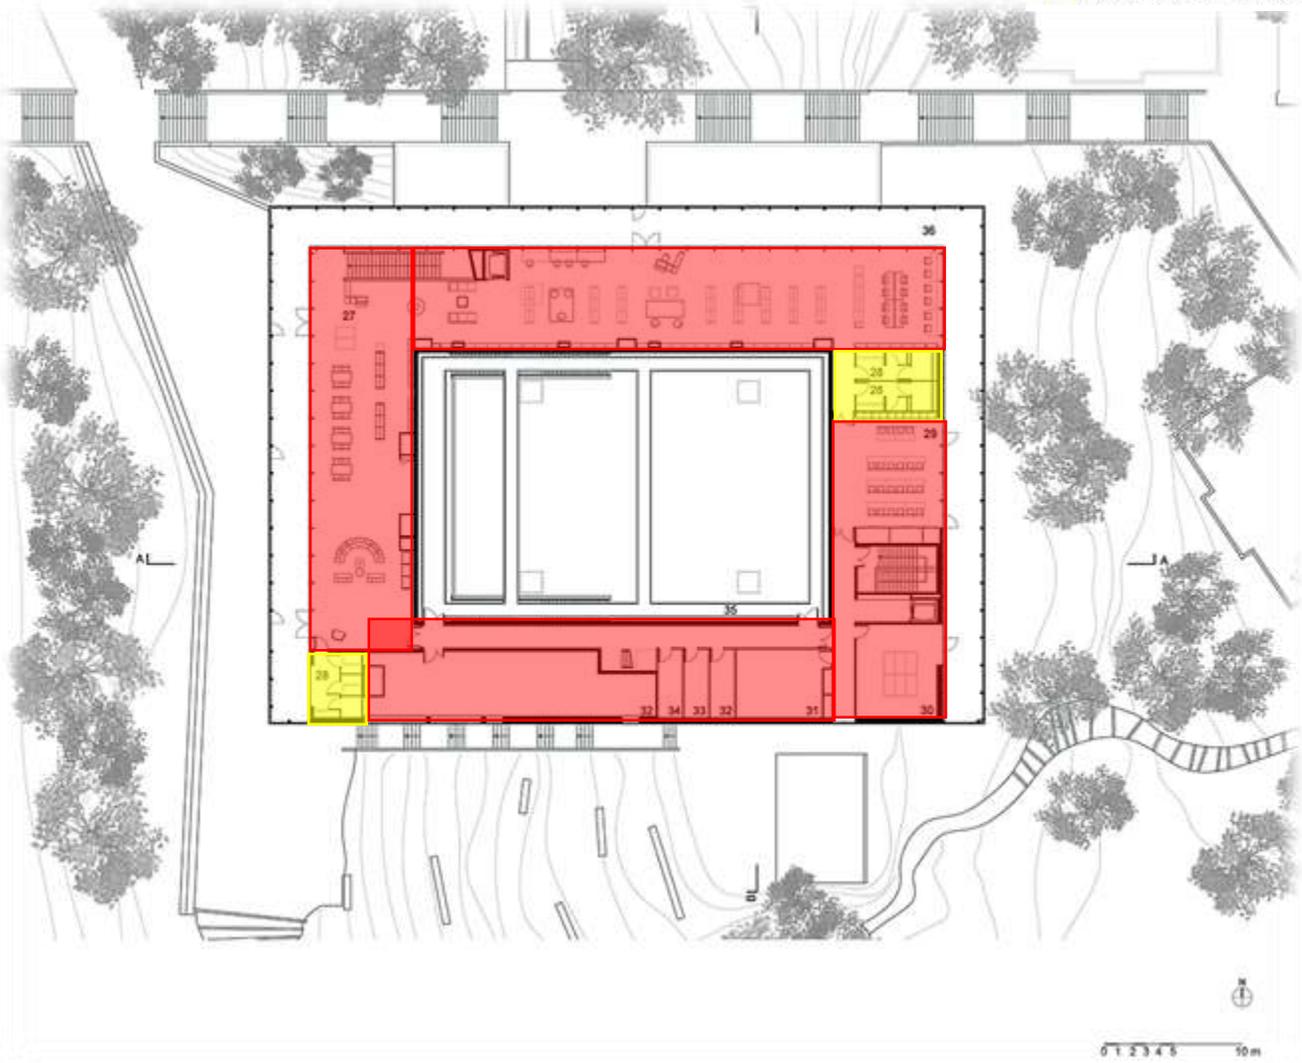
Planta Arquitectónica Tercer Nivel. Fuente: Hervé de Chastenot
